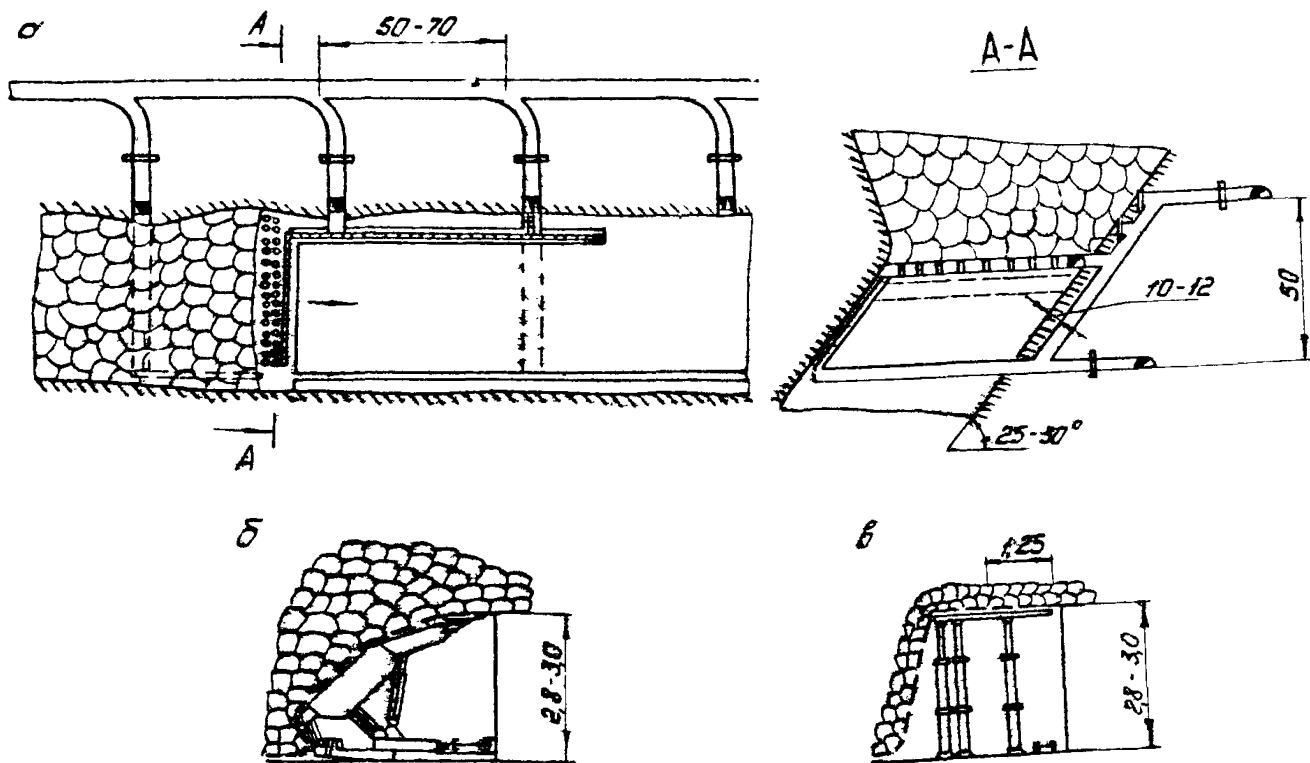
Схема подготовки и обработки выемочного пола горизонтальными слоями: а - схема вскрытия; б - вид на забой с механизированным комплексом; в - то же, с креплением призабойного пространства металлическими стойками
